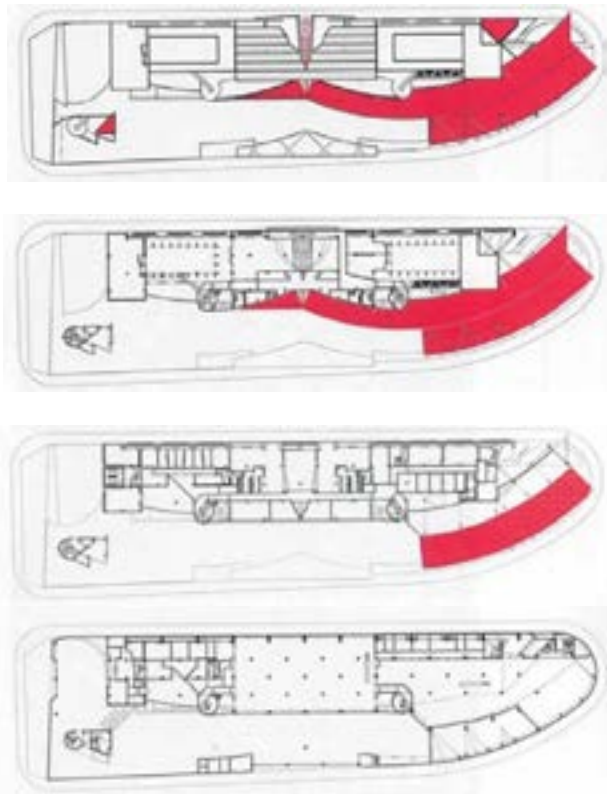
Plantas do POBAP; de baixo para cima, planta do Piso-Térreo à Cobertura, respectivamente. (Milheiro, 2010).
